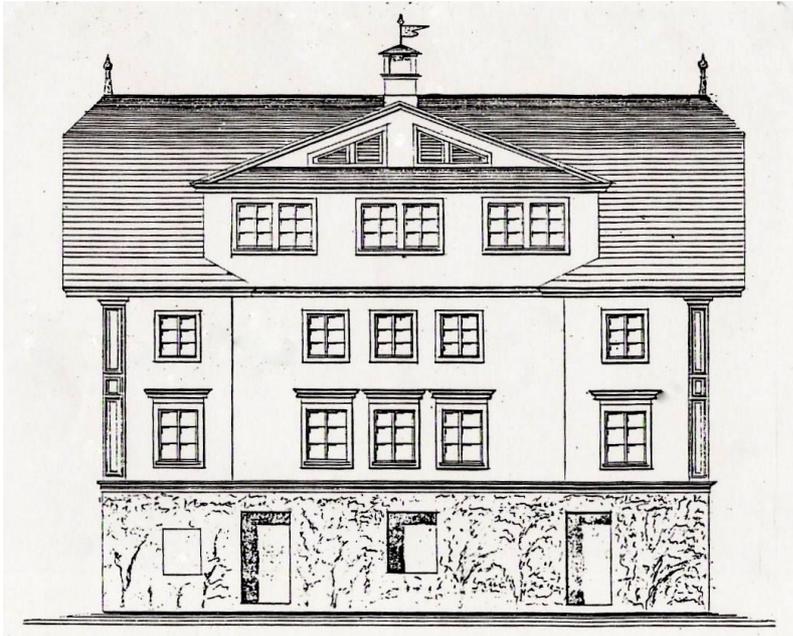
Das alte Moos-Haus (Südfassade) mit Krüpelwalmdach und grossem Dachgiebel. Auf dem Kamin befindet sich eine Wetterfahne (wohl mit Familienwappen) sowie an den beiden Enden des Dachfirstes je ein Dachknauf. An der Fassade mit den Sprossenfenstern sind an den Ecken pfeilerartige Formelemente als Dekor aufgemalt. Vermutlich war auch das Gesimse im ersten Stock nur aufgemalt. Im Erdgeschoss ist Spalierobst als vertikaler Garten angebracht. (FamA)
